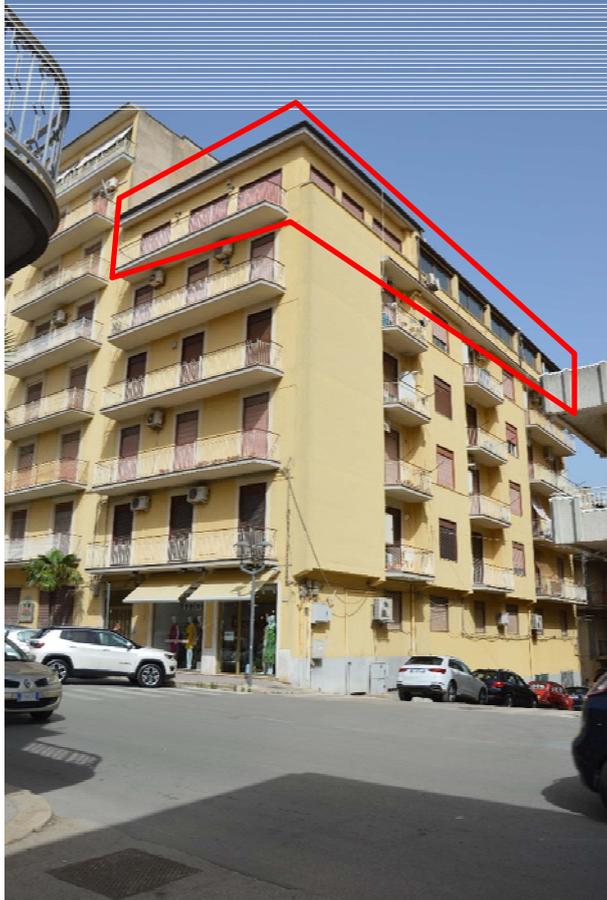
fg. 69 - part. 812 - Sub. 11 - Prospetto su via Augello
